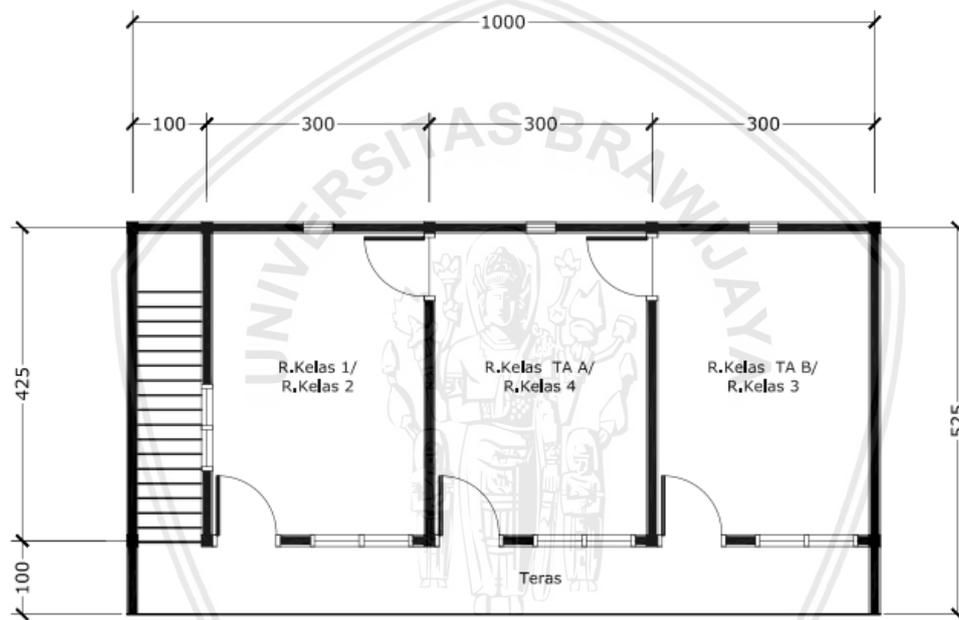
Site plan Ta-Mi Sunan Kalijaga Malang
